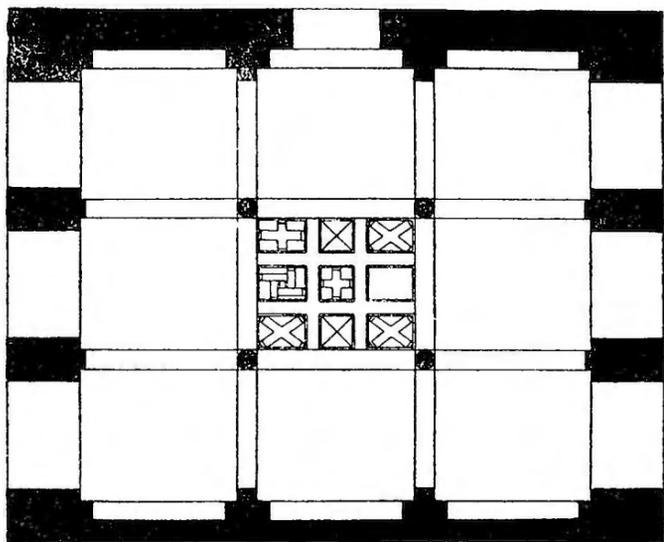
CASA DE LAS TORNERÍAS: PLANTA SUPERIOR.
